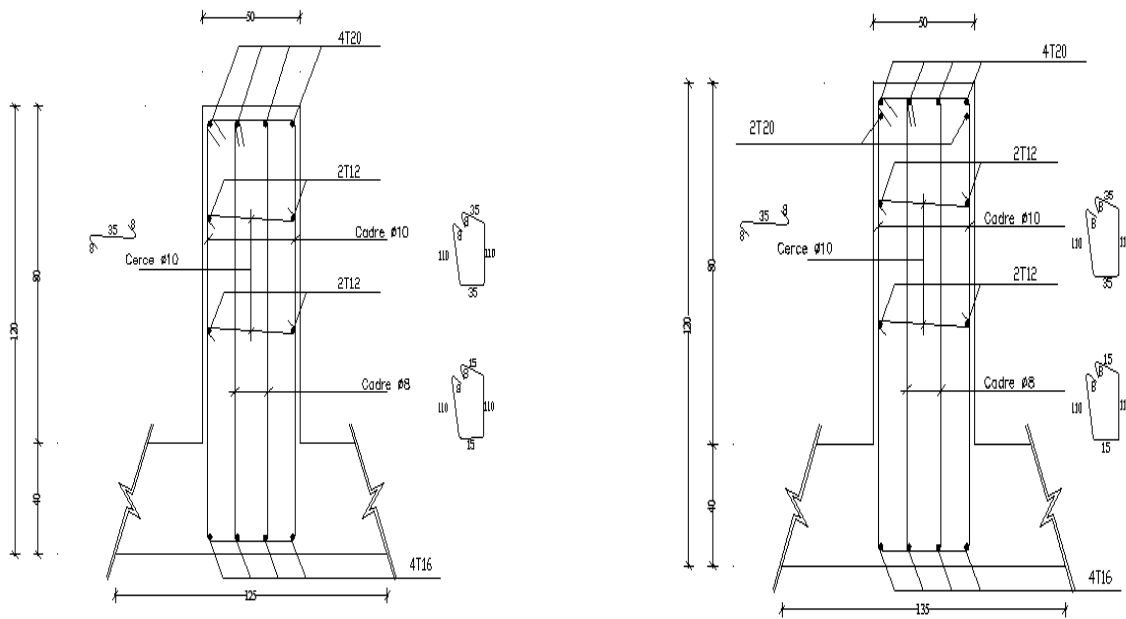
Dessin ferrailage des poutres secondaires de radier
